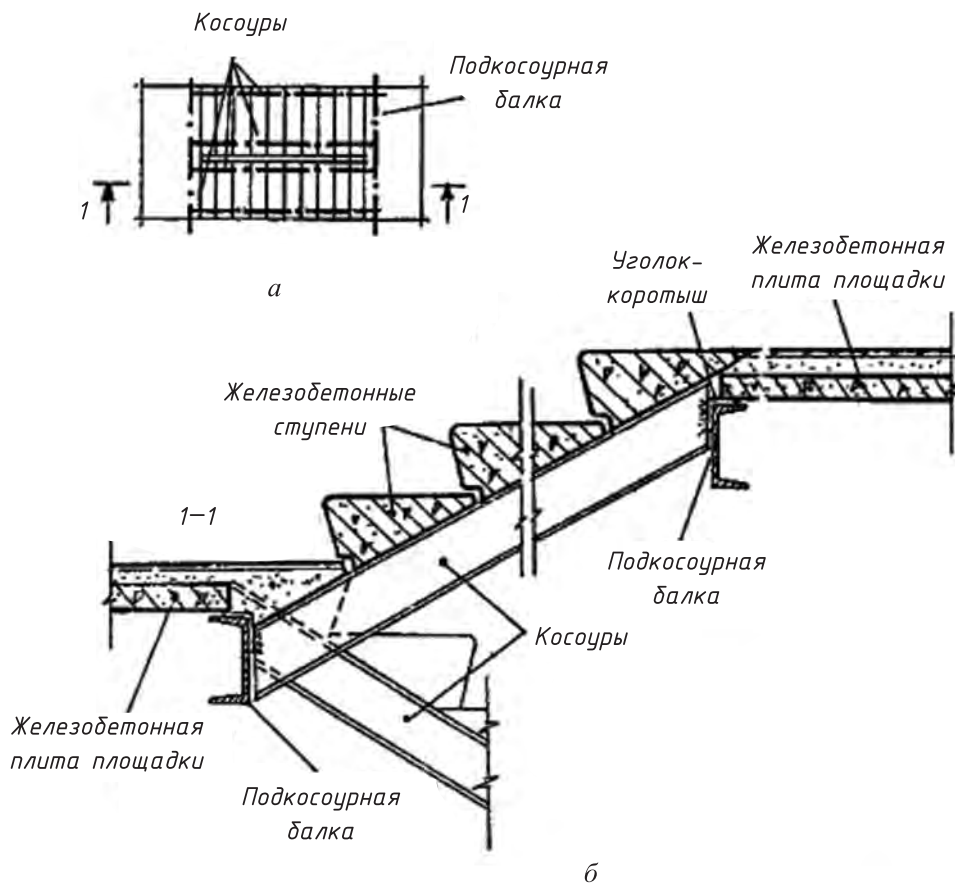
Сборные лестницы по металлическим косоурам: а — план; б — разрез
